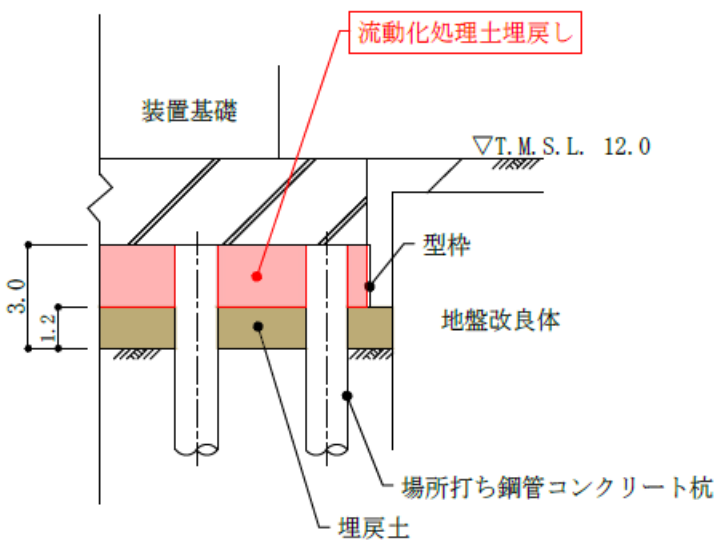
掘削範囲埋戻しの施工手順 (1/3) (単位 : m)
